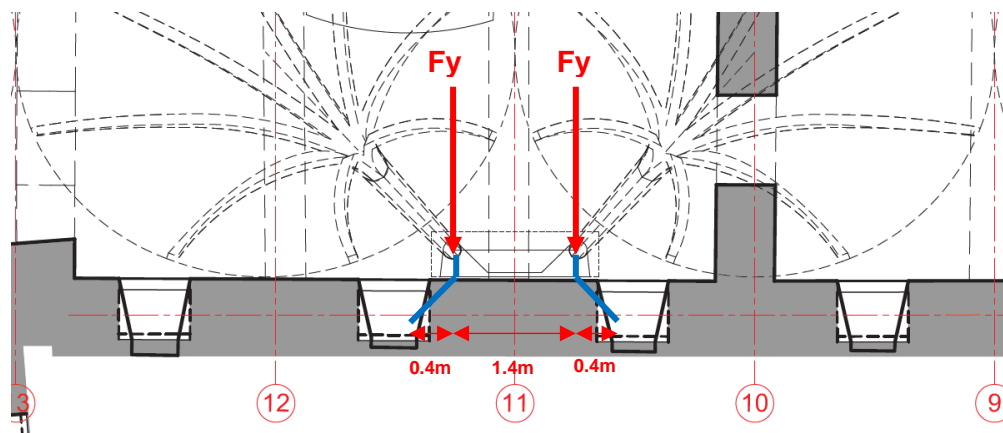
Principe de diffusion des efforts horizontaux des poteaux le long de la façade contemporaine
